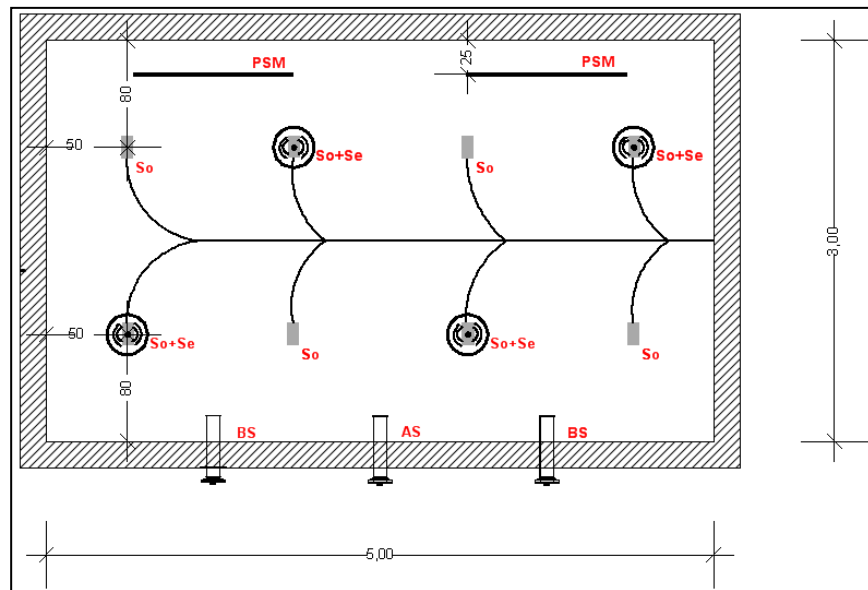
Skizze Pelletlager ohne Schrägen mit Sonden
